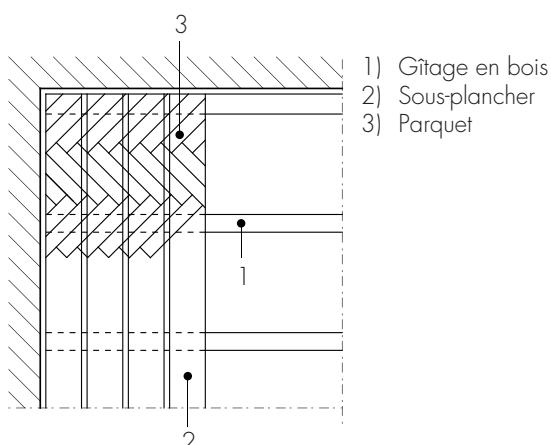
Gîtage en bois avec sous-plancher en bois en panneaux.
